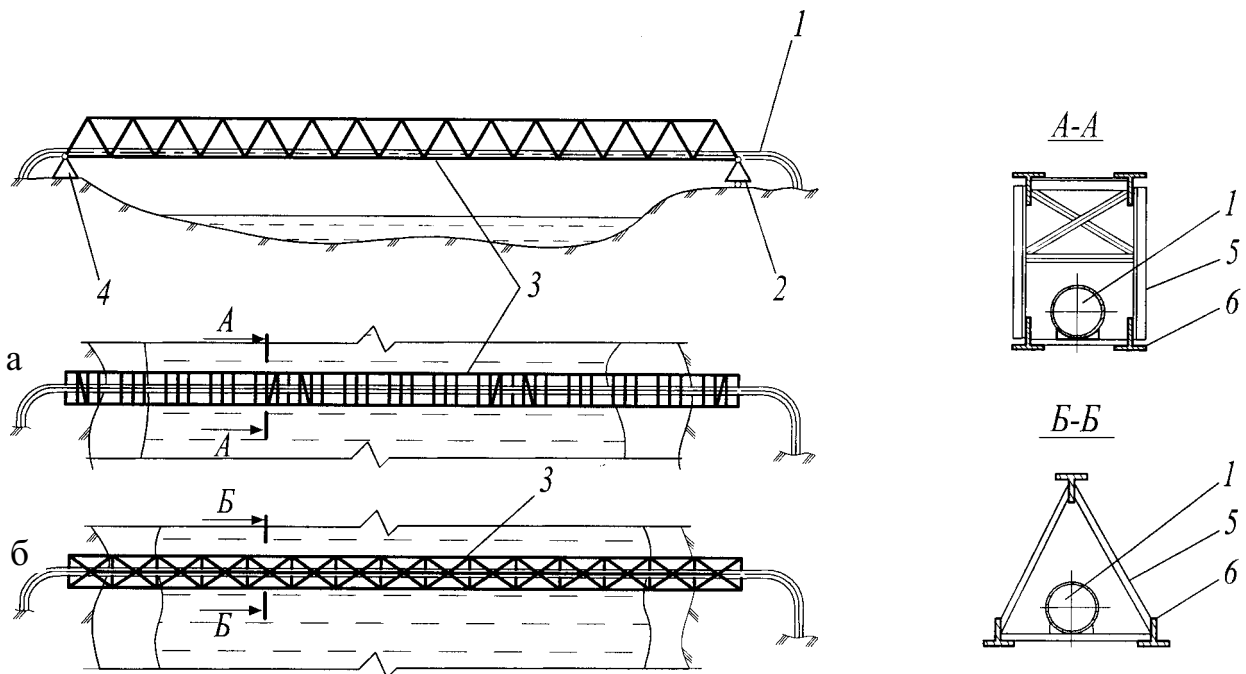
Трубопроводный переход с поддерживающим элементом рабочего трубопровода в виде фермы:
